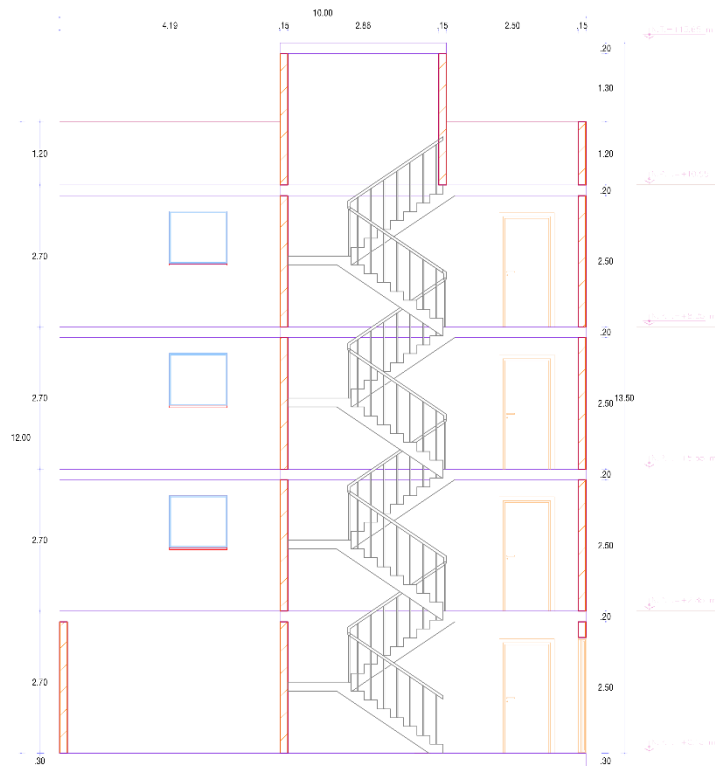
Plano Arquitectónico de Corte en Elevación D-D'.
